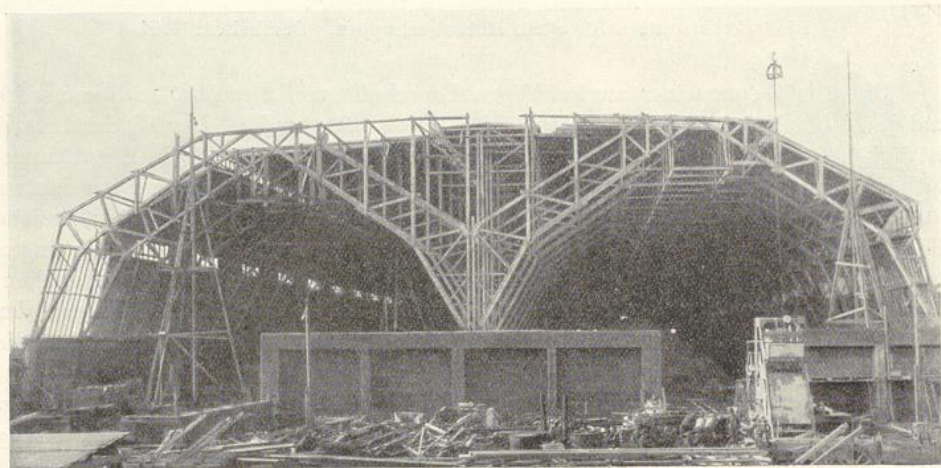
System „Deutsche Hallenbau A.-G.“ (Dehall). Zweischiffige Lagerhalle.
